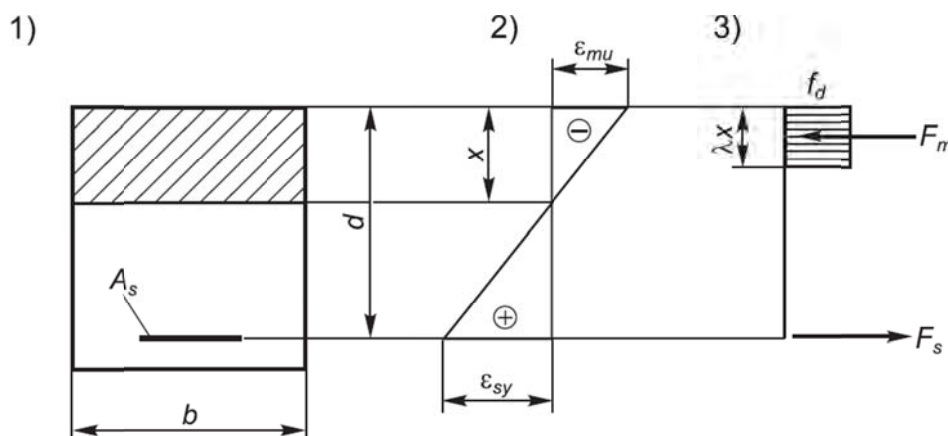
Расчетная схема деформаций и усилий в сечении изгибаемого элемента:
